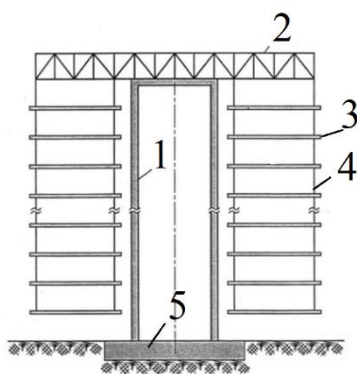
Сейсмостойкое здание с подвешенными этажами: 1 – ядро жёсткости; 2 – консольная ферма, 3 – перекрытия; 4 – подвески; 5 – фундамент
